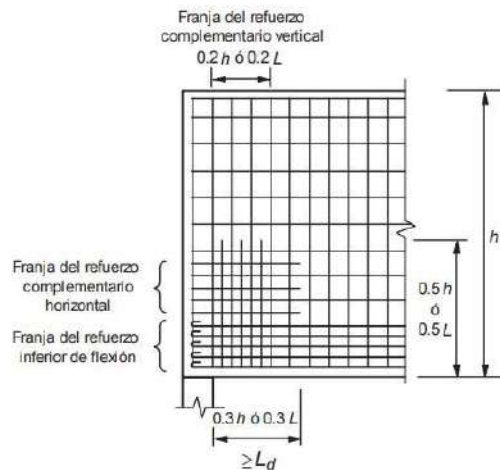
Refuerzo complementario en una zona de apoyo directo de una viga diafragma no atiesada
